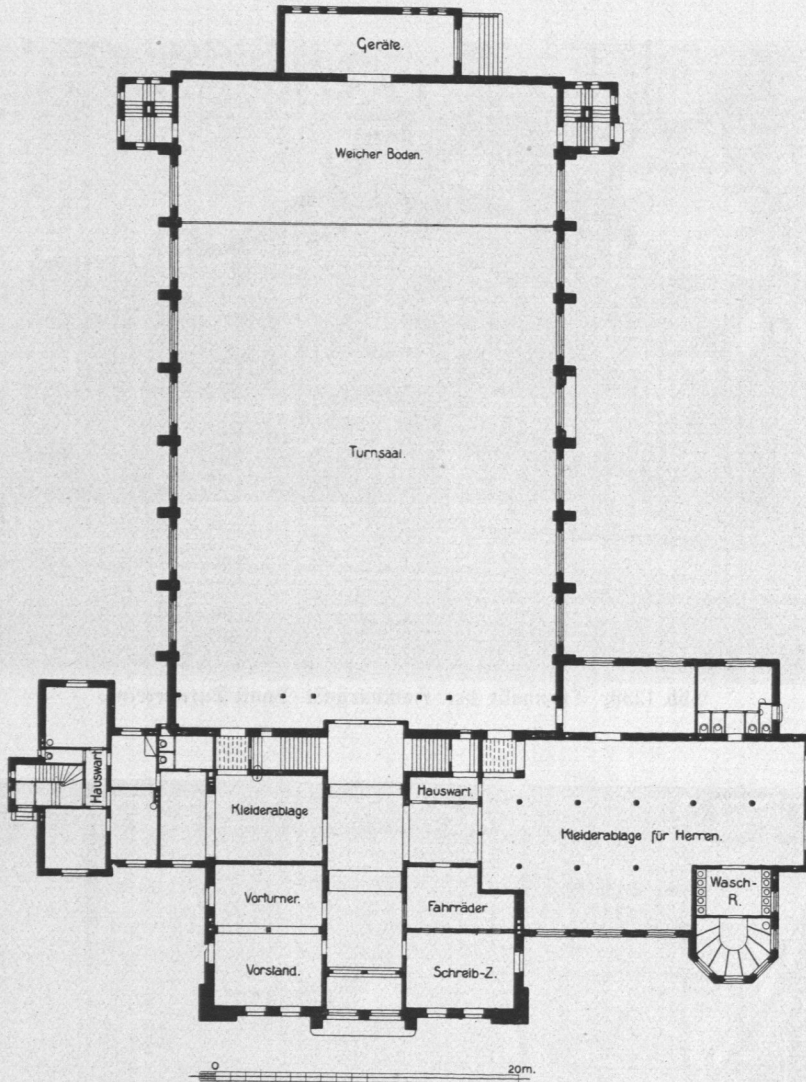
Turnhalle des Hamburg-St.-Pauli-Turnvereins, Grundriß.
